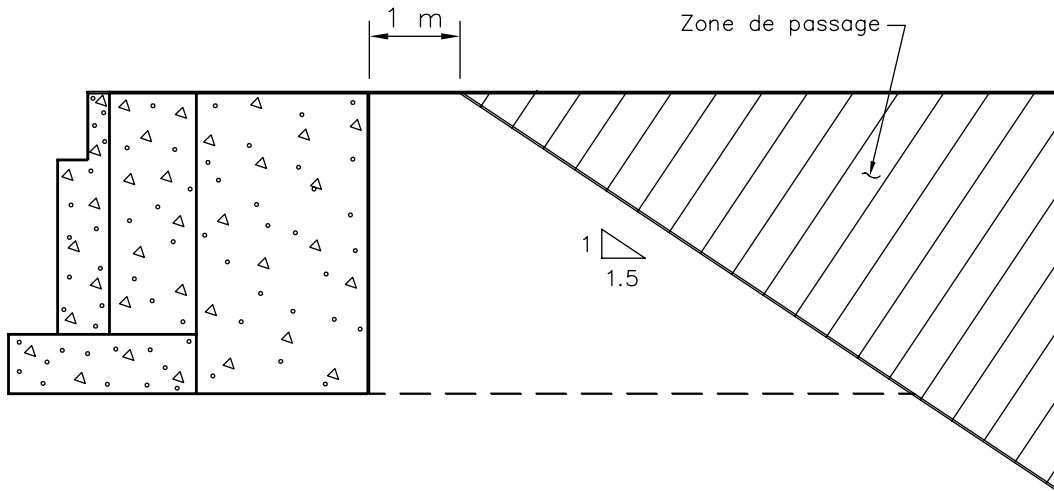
Zone de passage d'un conduit ou d'un groupe de conduits au bout d'un mur
